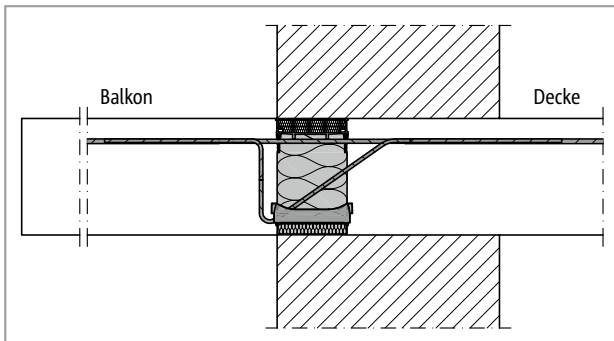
Schöck Isokorb® XT Typ K: REI 120 in einschaligem Mauerwerk
